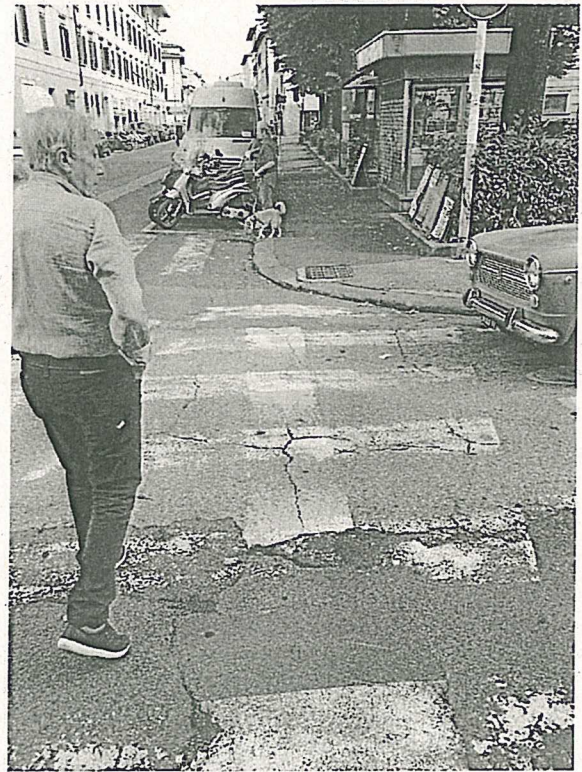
Attraversamenti pedonali Piazza Pier Vettori
